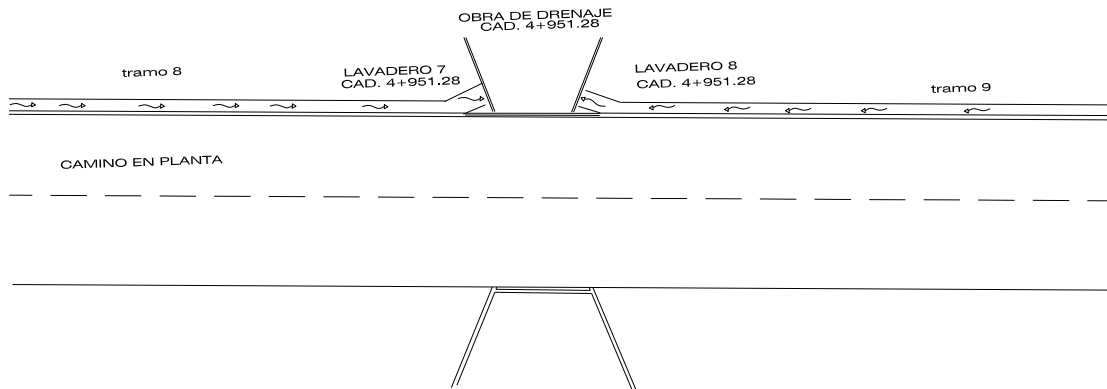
Ubicación de lavadero 7 y 8 salida hacia alcantarilla cad. 4+951.28
